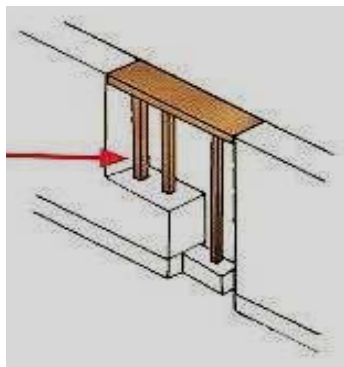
Exemplo para preenchimento do espaço para janelas e portas (VIGO e SCHMIDT, 2008).
